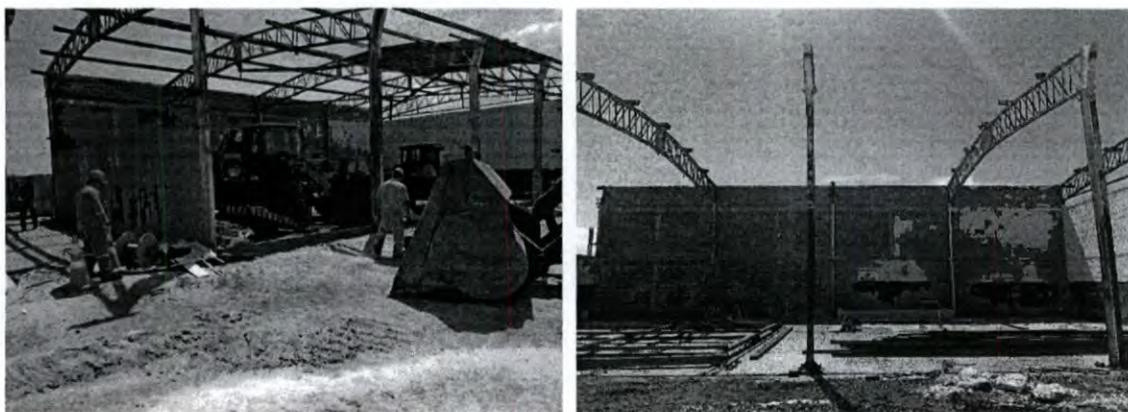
Adequação da Garagem do Maquinário (A) com impermeabilização e cobertura. (B)
